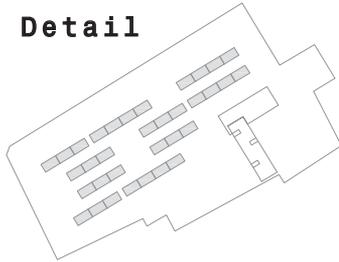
Abb. V: Übersicht Wegeführung am Lageplan (Maßstabslos) Pläne im Maßstab 1\_500 siehe Schubert für Pläne-Kapitel 3, Der Basar\_Lageplan A0
